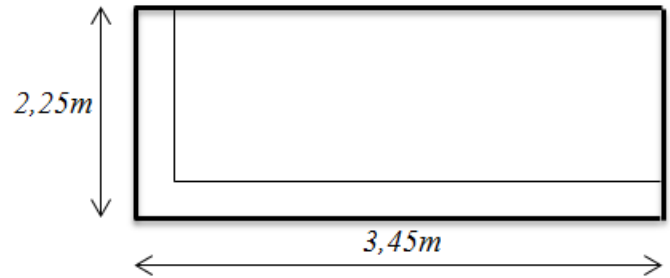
schéma de ferrailage de la dalle pleine sur deux appuis.
